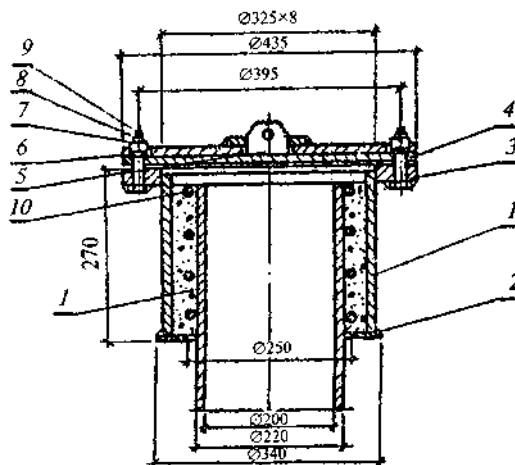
Схема установки заглушки на вентиляционной асбестоцементной трубе на существующих резервуарах
